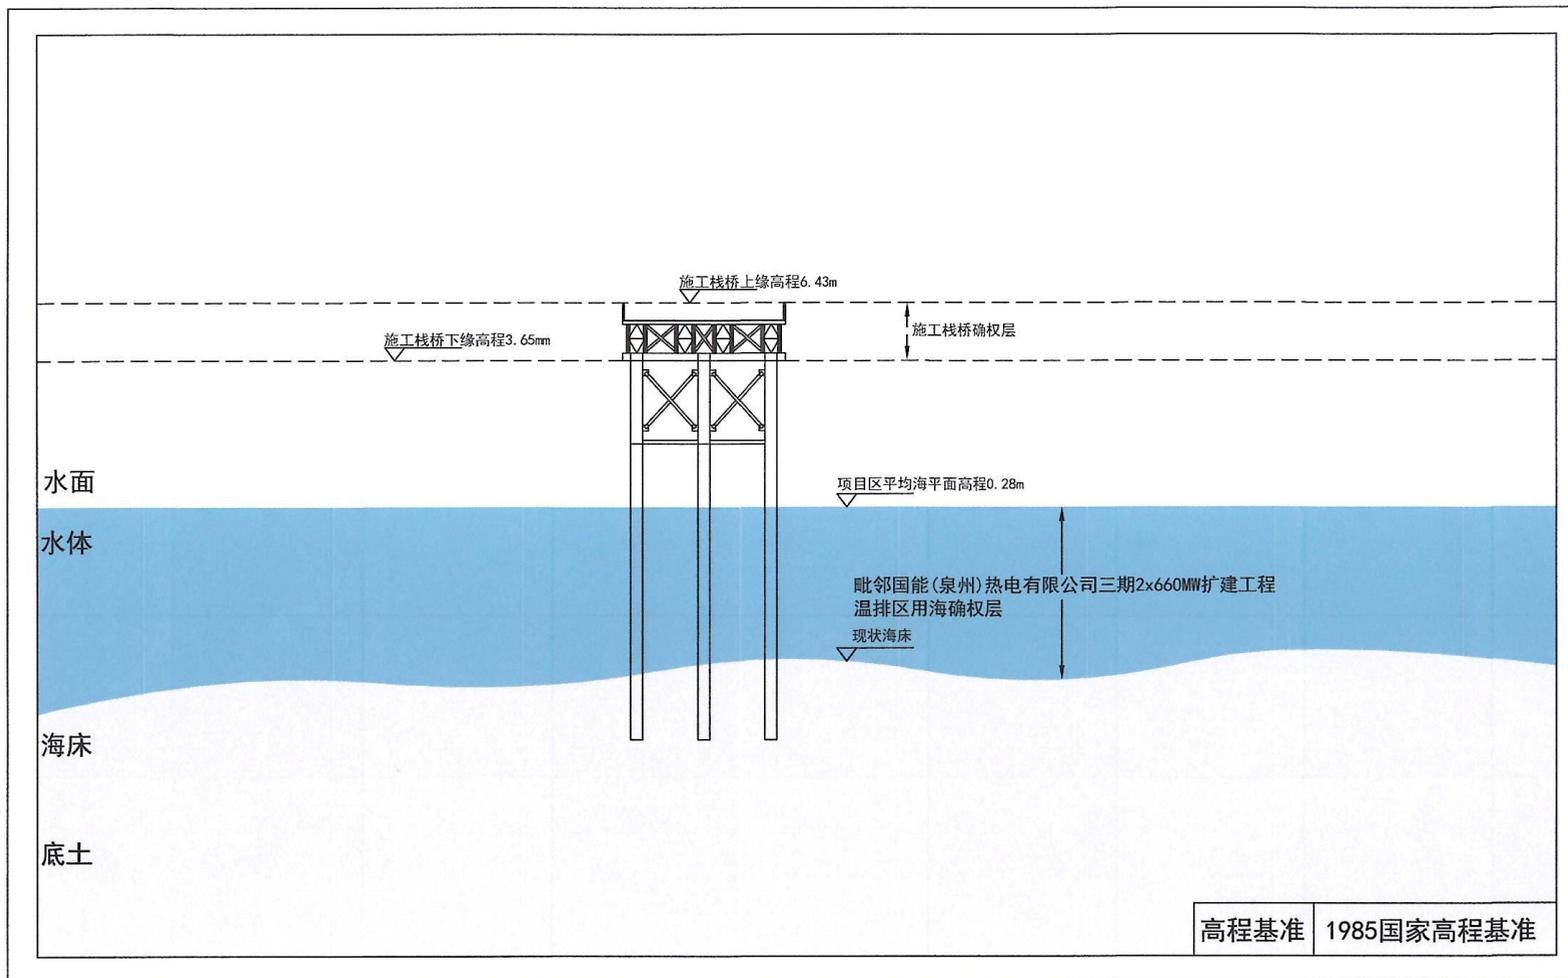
宗海立体空间范围示意图 (施工栈桥)
